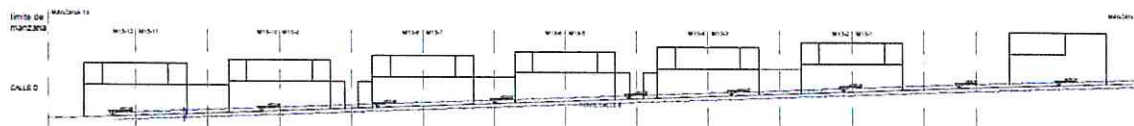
Sección Calle 6. Fuente: Elaboración propia.
